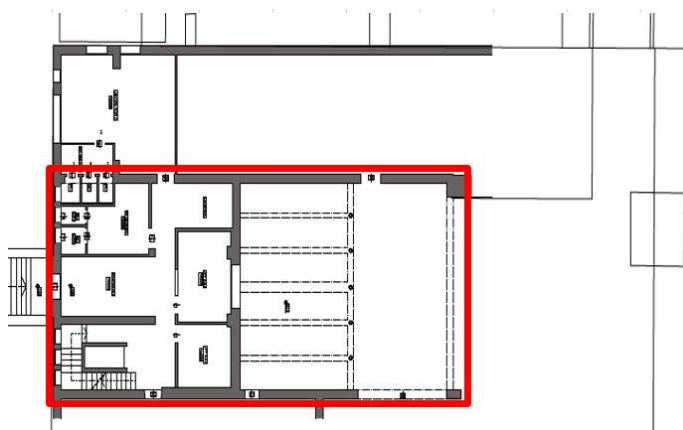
STATO DI FATTO: Pianta del piano terra, in rosso l'impronta dell'edificio originario della centrale del latte
